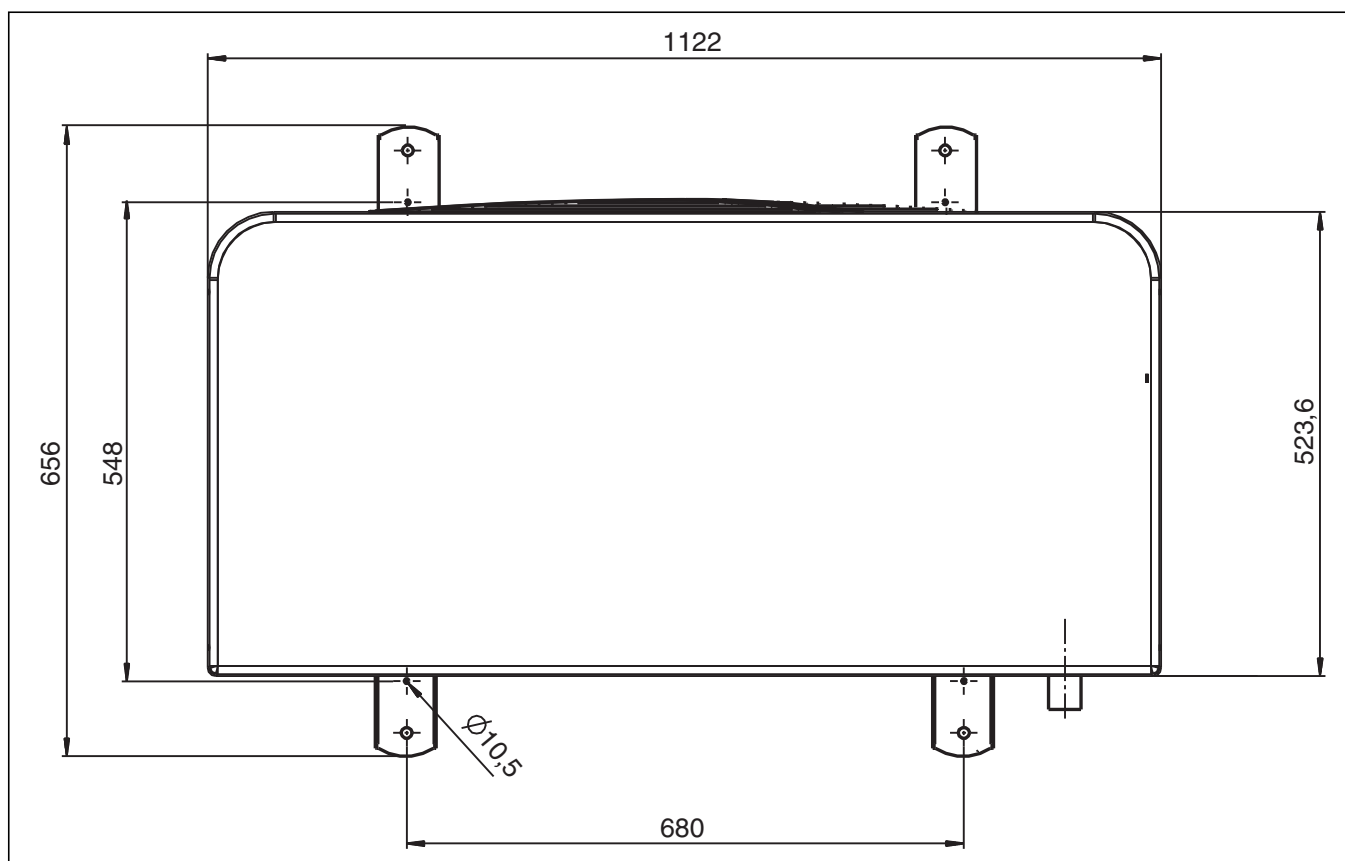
Dimensioni del modello di pompa di calore AW 13-17, vista dall'alto
